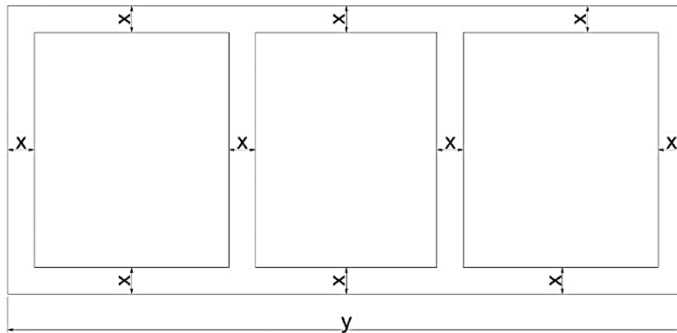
2. Üst yapı 2. parça grasshopper yapılanması
